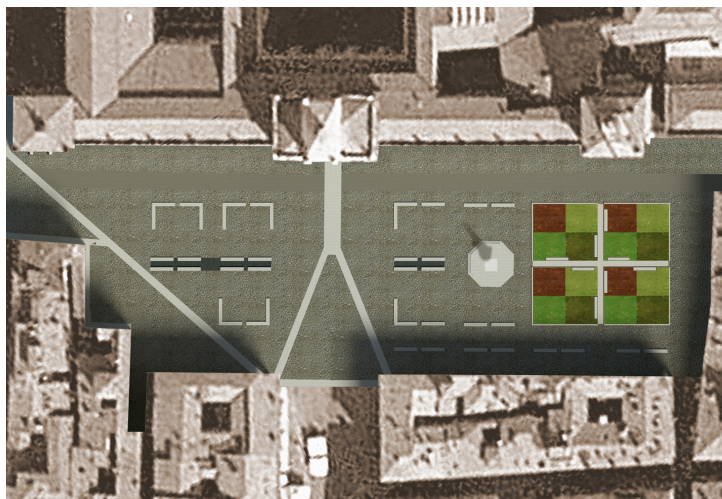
Prima proposta progettuale dell'Arch. Cerfogli: pianta
